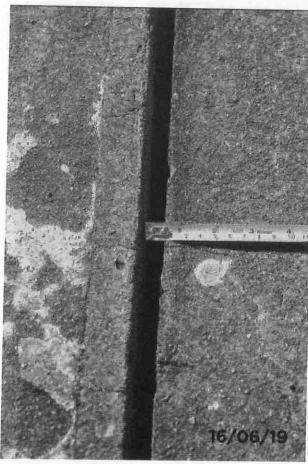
Detalhe da Junta de dilatação entre o viaduto e a passarela.
